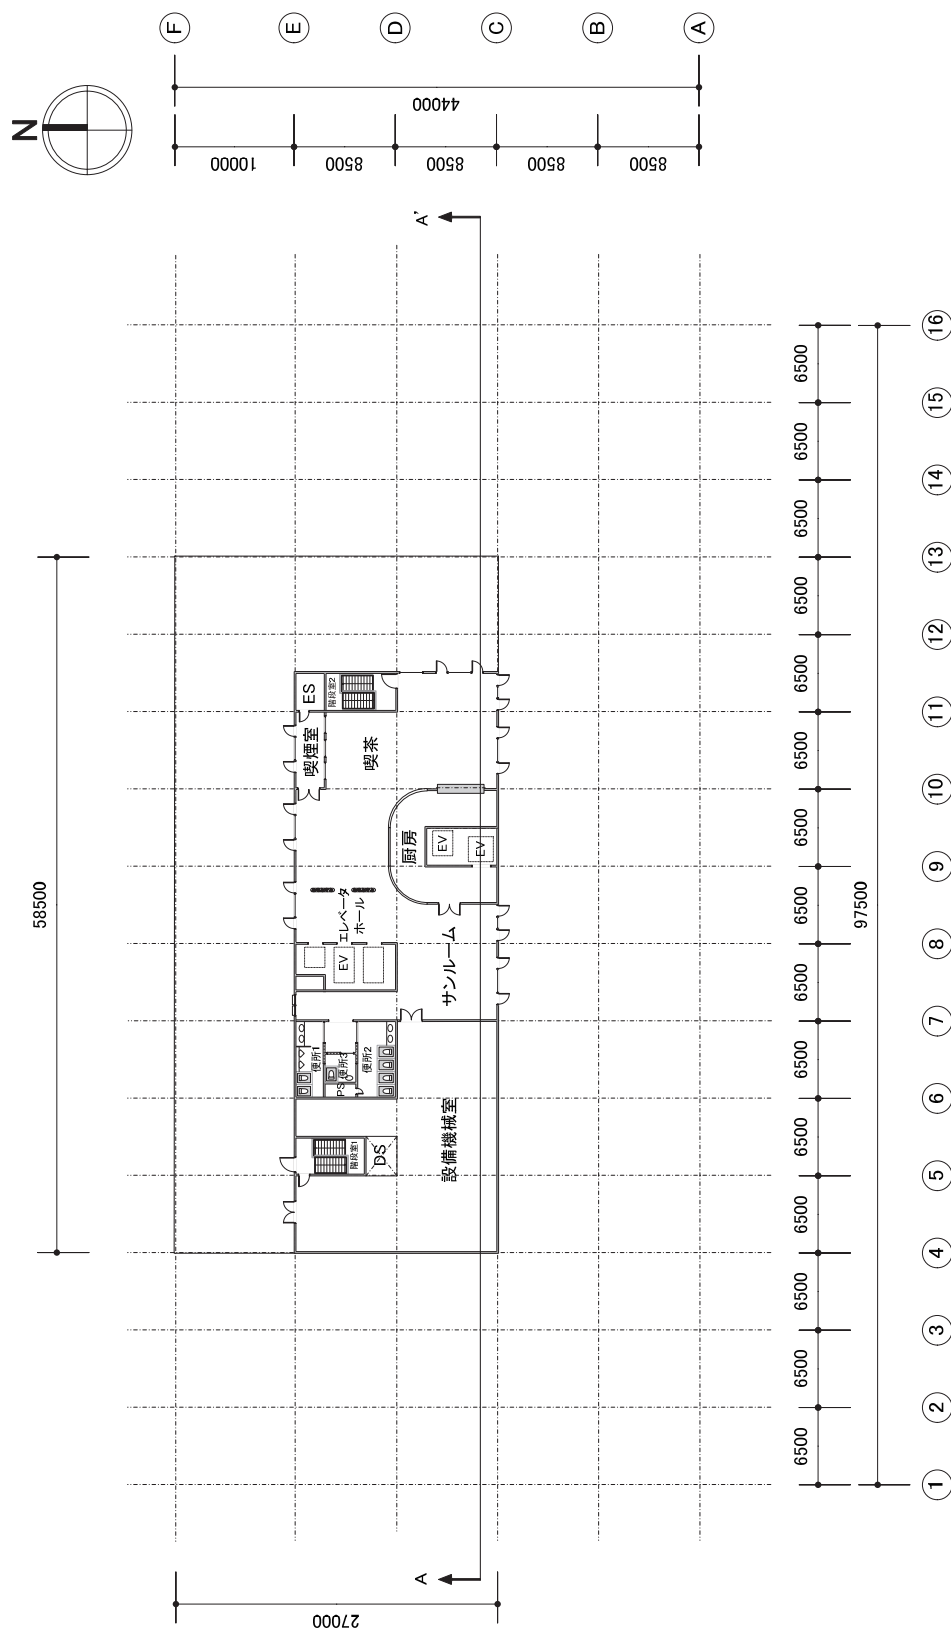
A.13 モデル建物 (病院等、20,000㎡) 7階平面図
